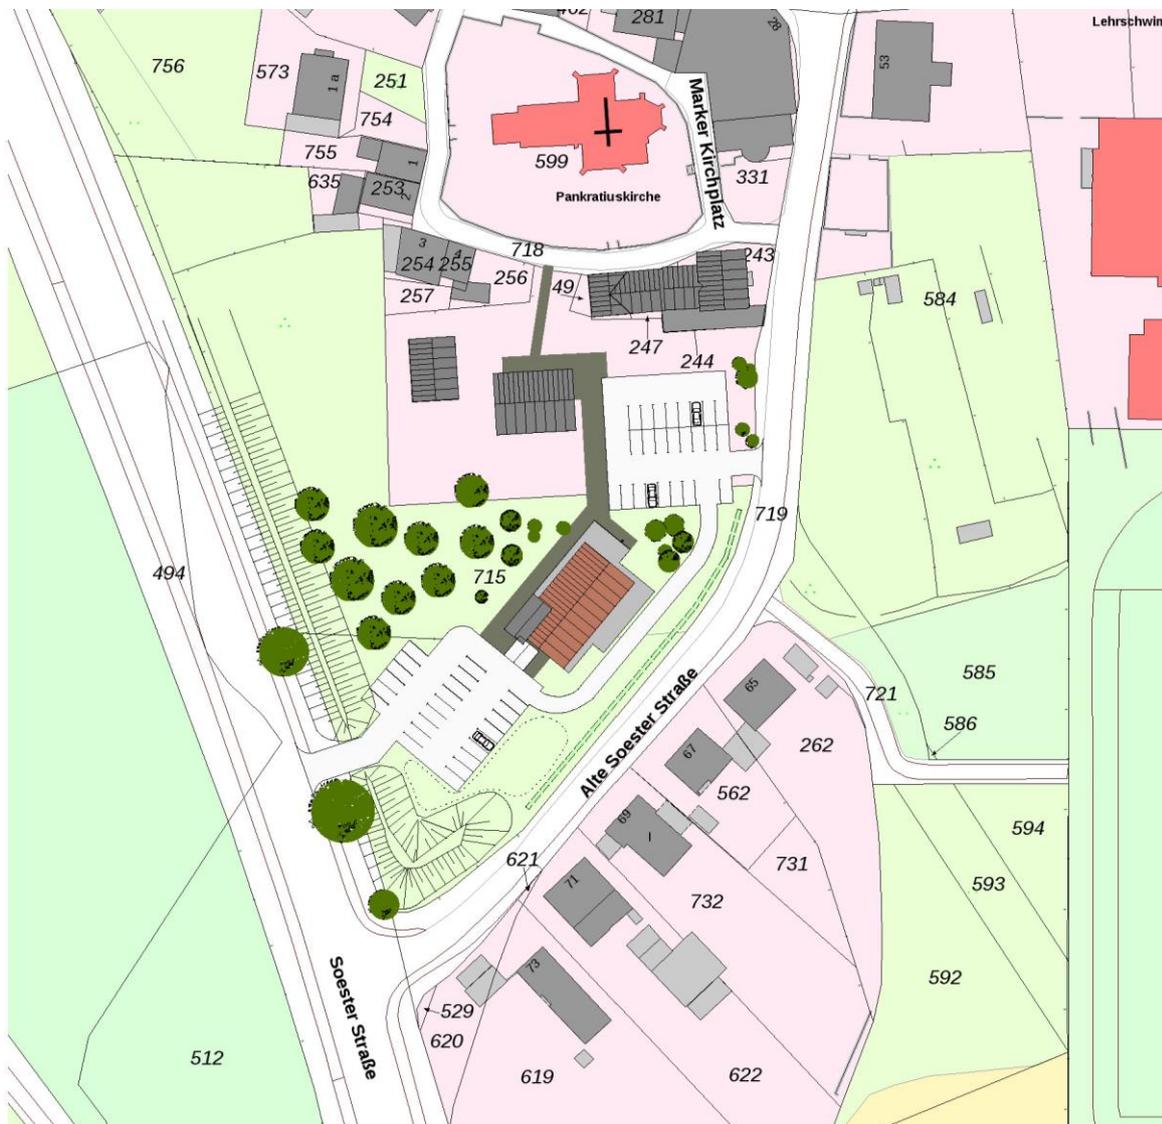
Lageplanentwurf (Stand April 2020, ohne Maßstab, Verfasser: Dipl.-Ing. Klaus Filbert)
